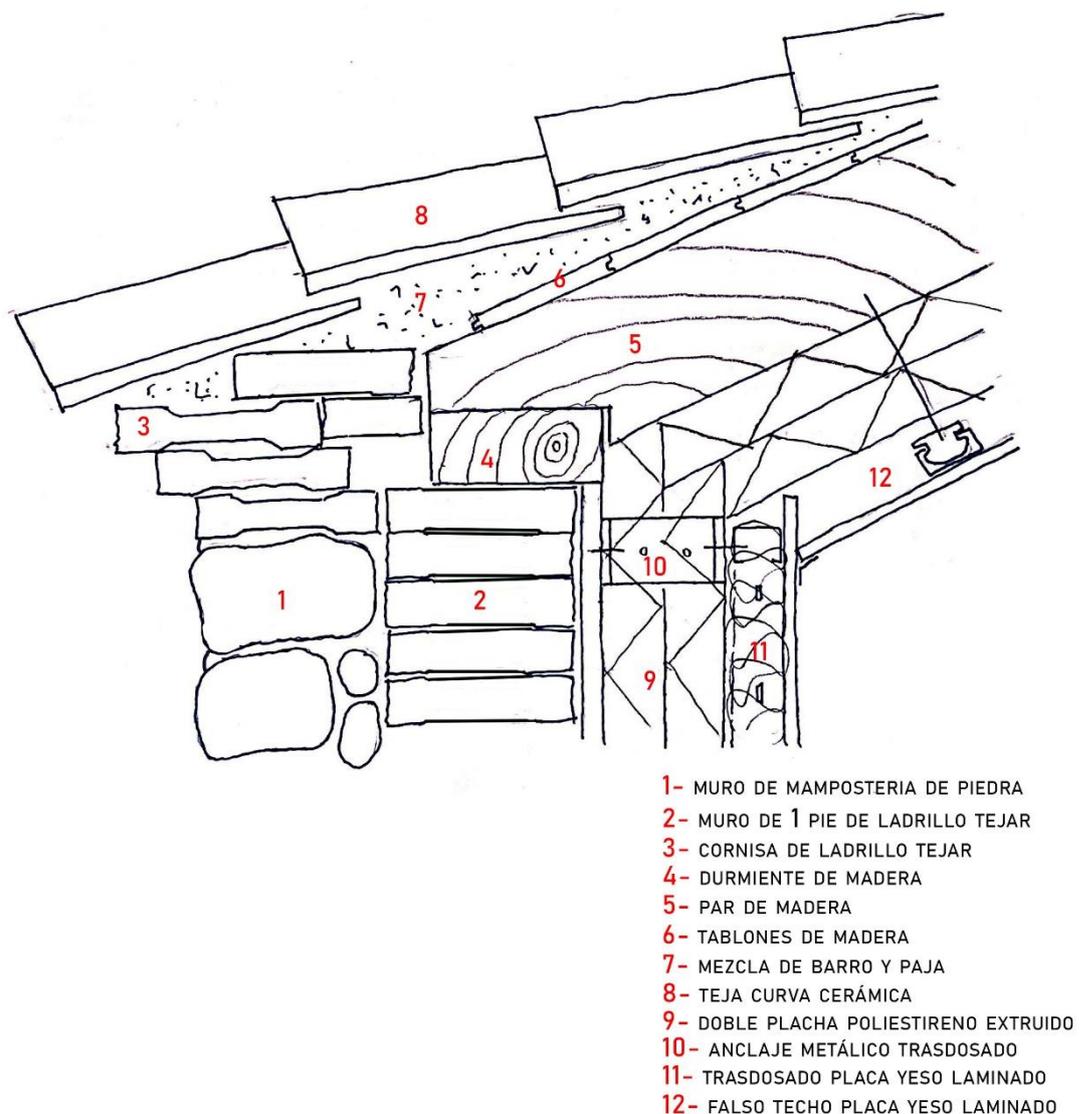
Detalle constructivo reformado – Cubierta (2 alturas)
